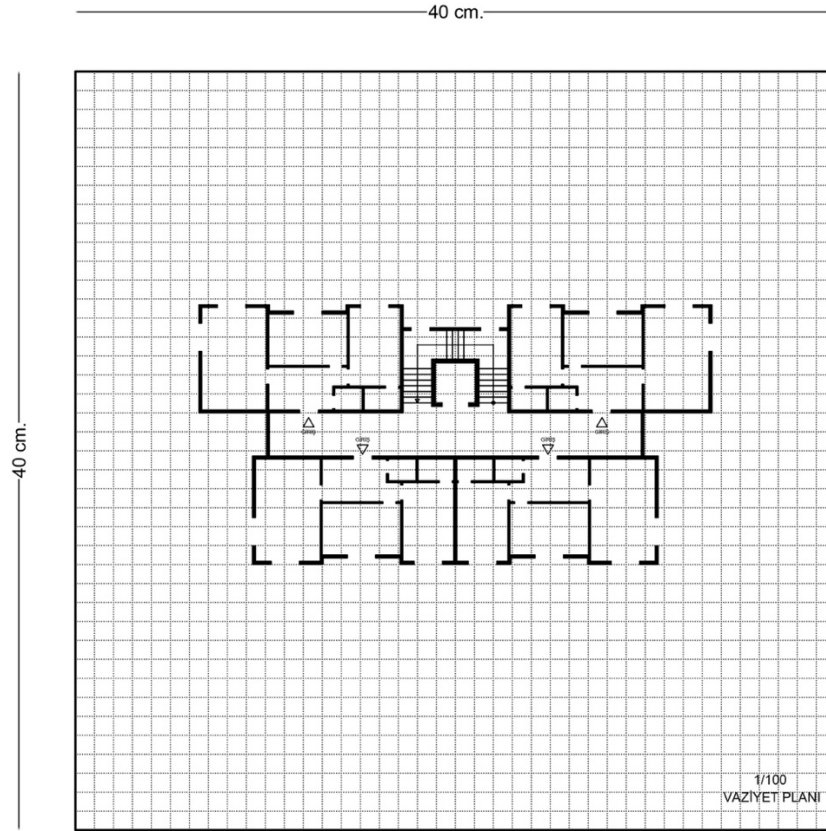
1/50 Plan, 40x40 cm. Pileksi Yazı Tahtası
